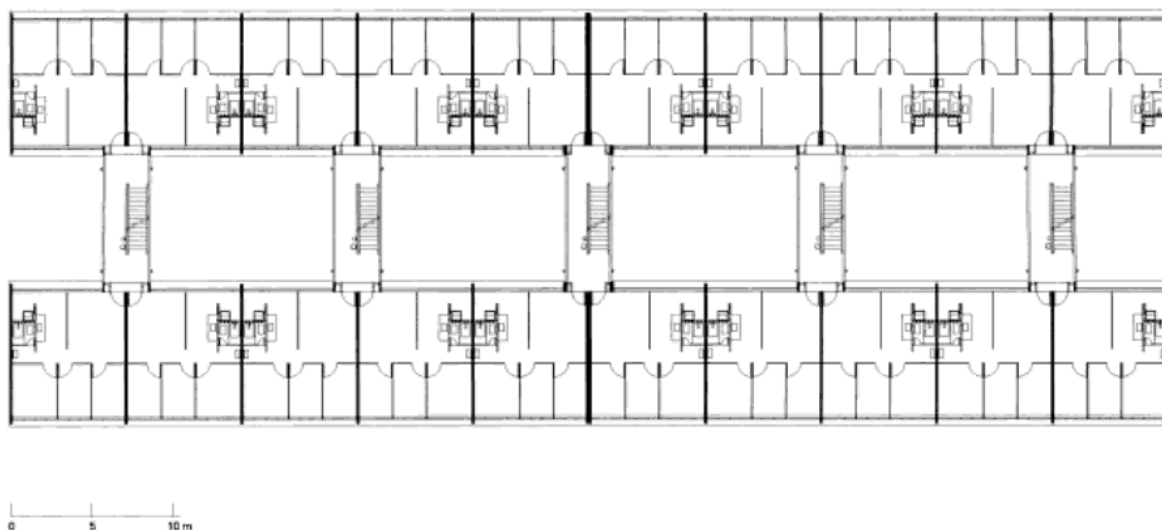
Planta do bloco padrão dos apartamentos tipo 1 do *Conjunto Zezinho Magalhães Prado*. Fonte: Artigas, 2000, p. 186.
